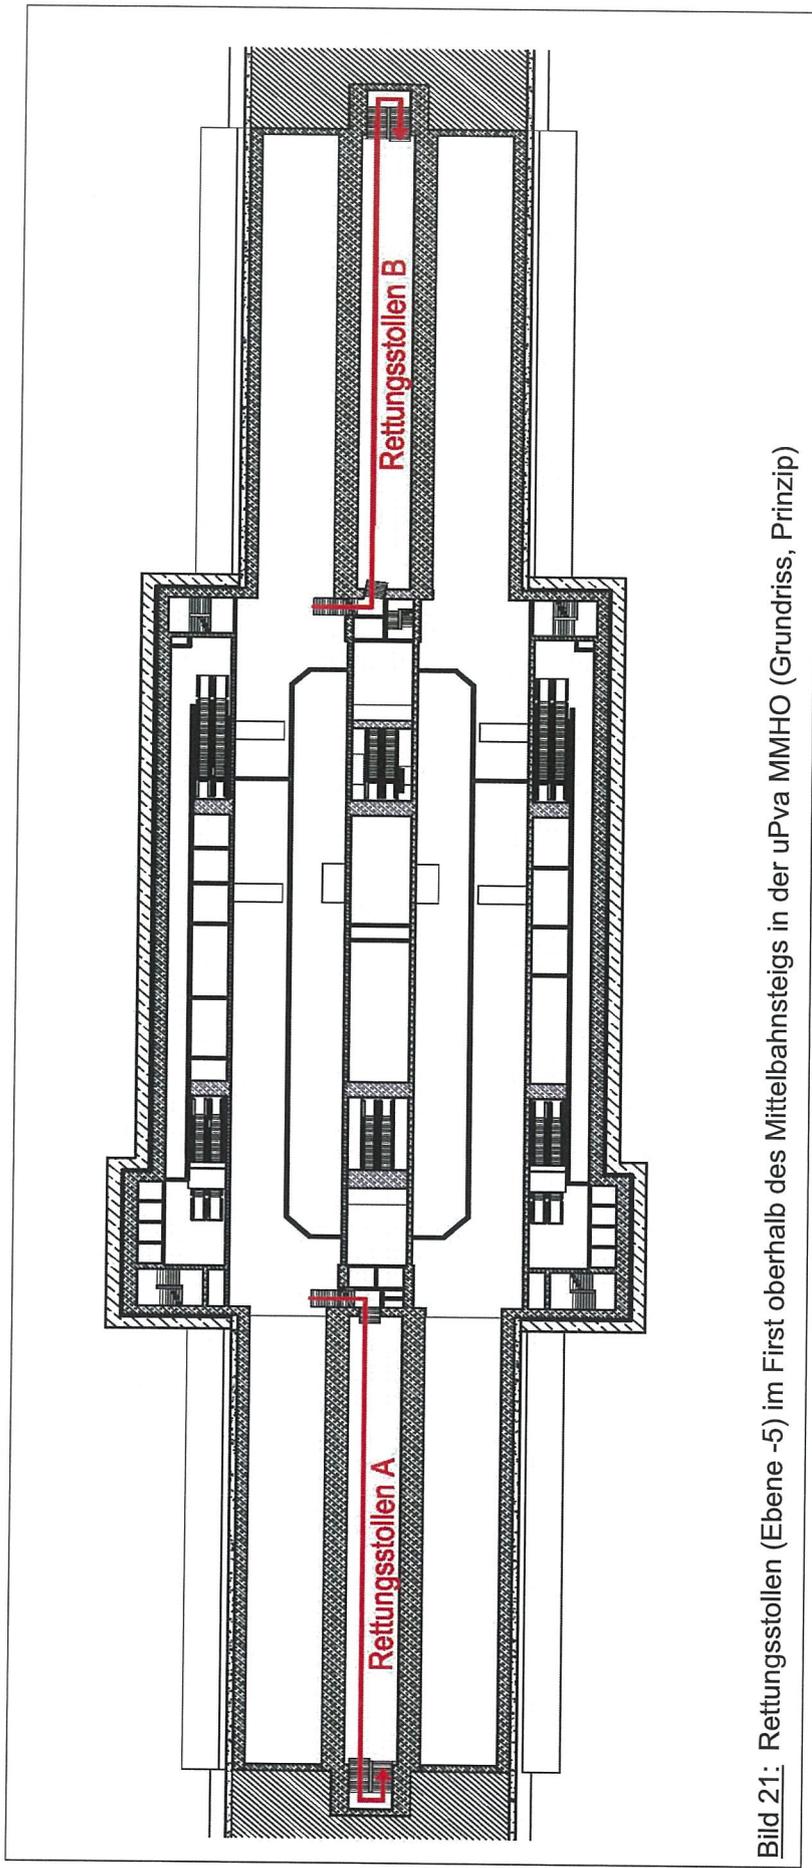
Rettungsstollen (Ebene -5) im First oberhalb des Mittelbahnsteigs in der uPva MMHO (Grundriss, Prinzip)
